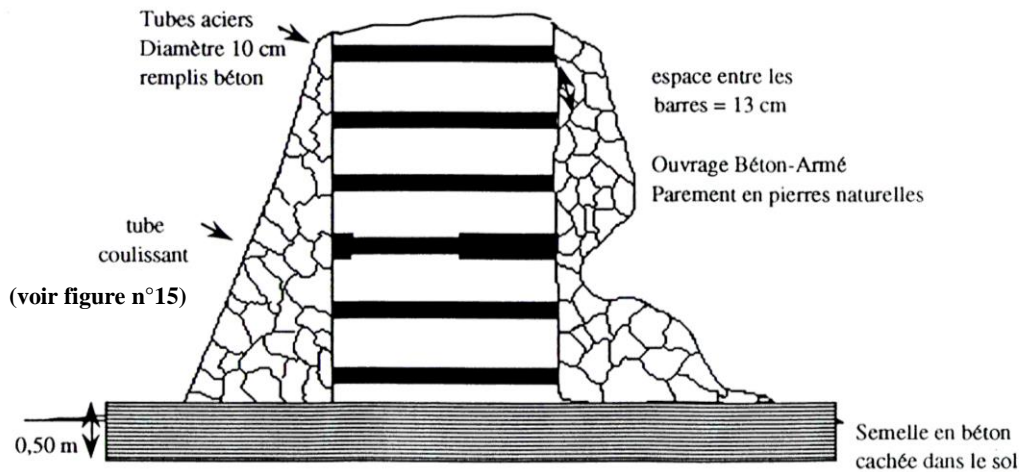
Schéma type d'une fermeture de cavité à l'aide de tubes en acier horizontaux
